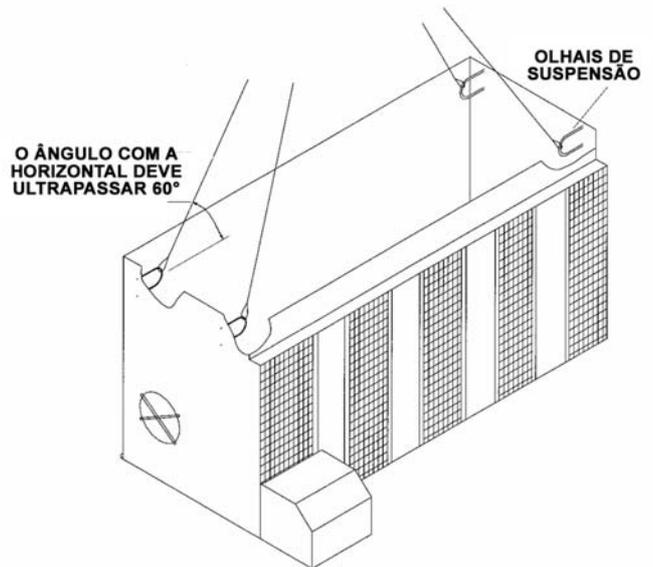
Secção da bacia / ventilador (até aos 5,5 metros de comprimento)
